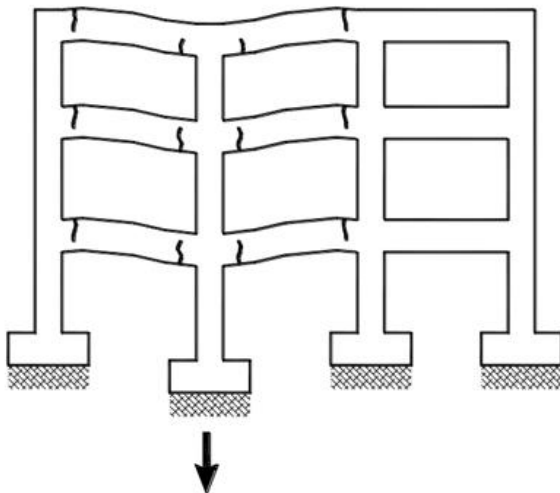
Detalle de fisuración de columna intermedia
